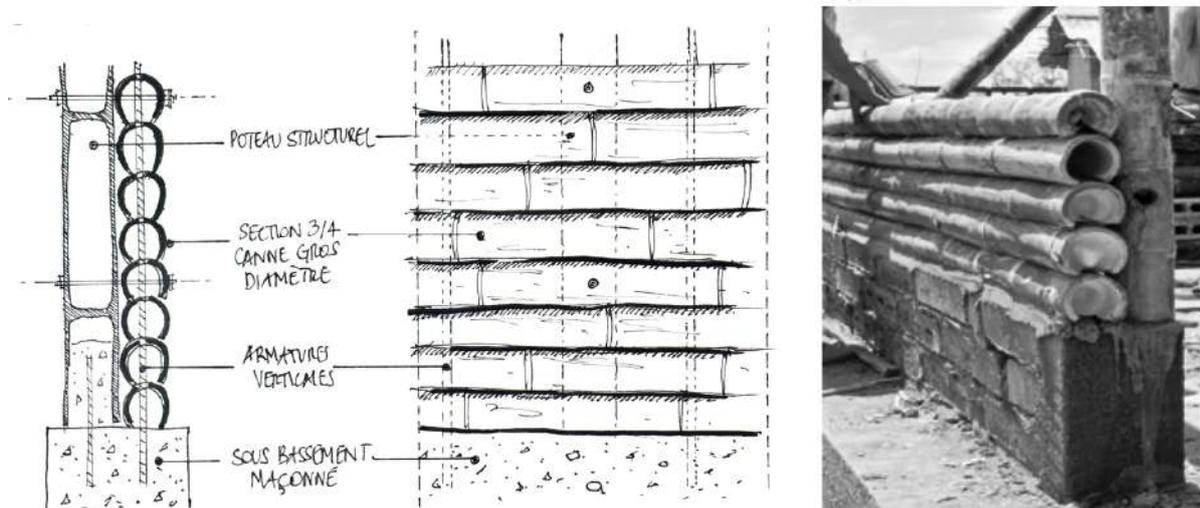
Paroi réalisée par empilement de cannes entières de gros diamètre, coupe et façade détail (croquis personnel), photographie de mise en œuvre (Building with Bamboo, Gernot Minke)
